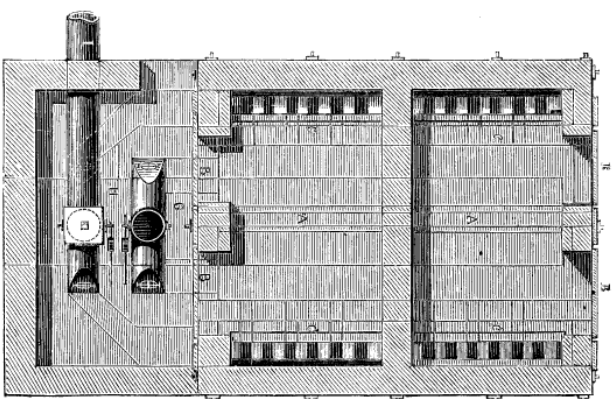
Vue en plan au-dessus de la sole du four et la chambre des valves découverte.
